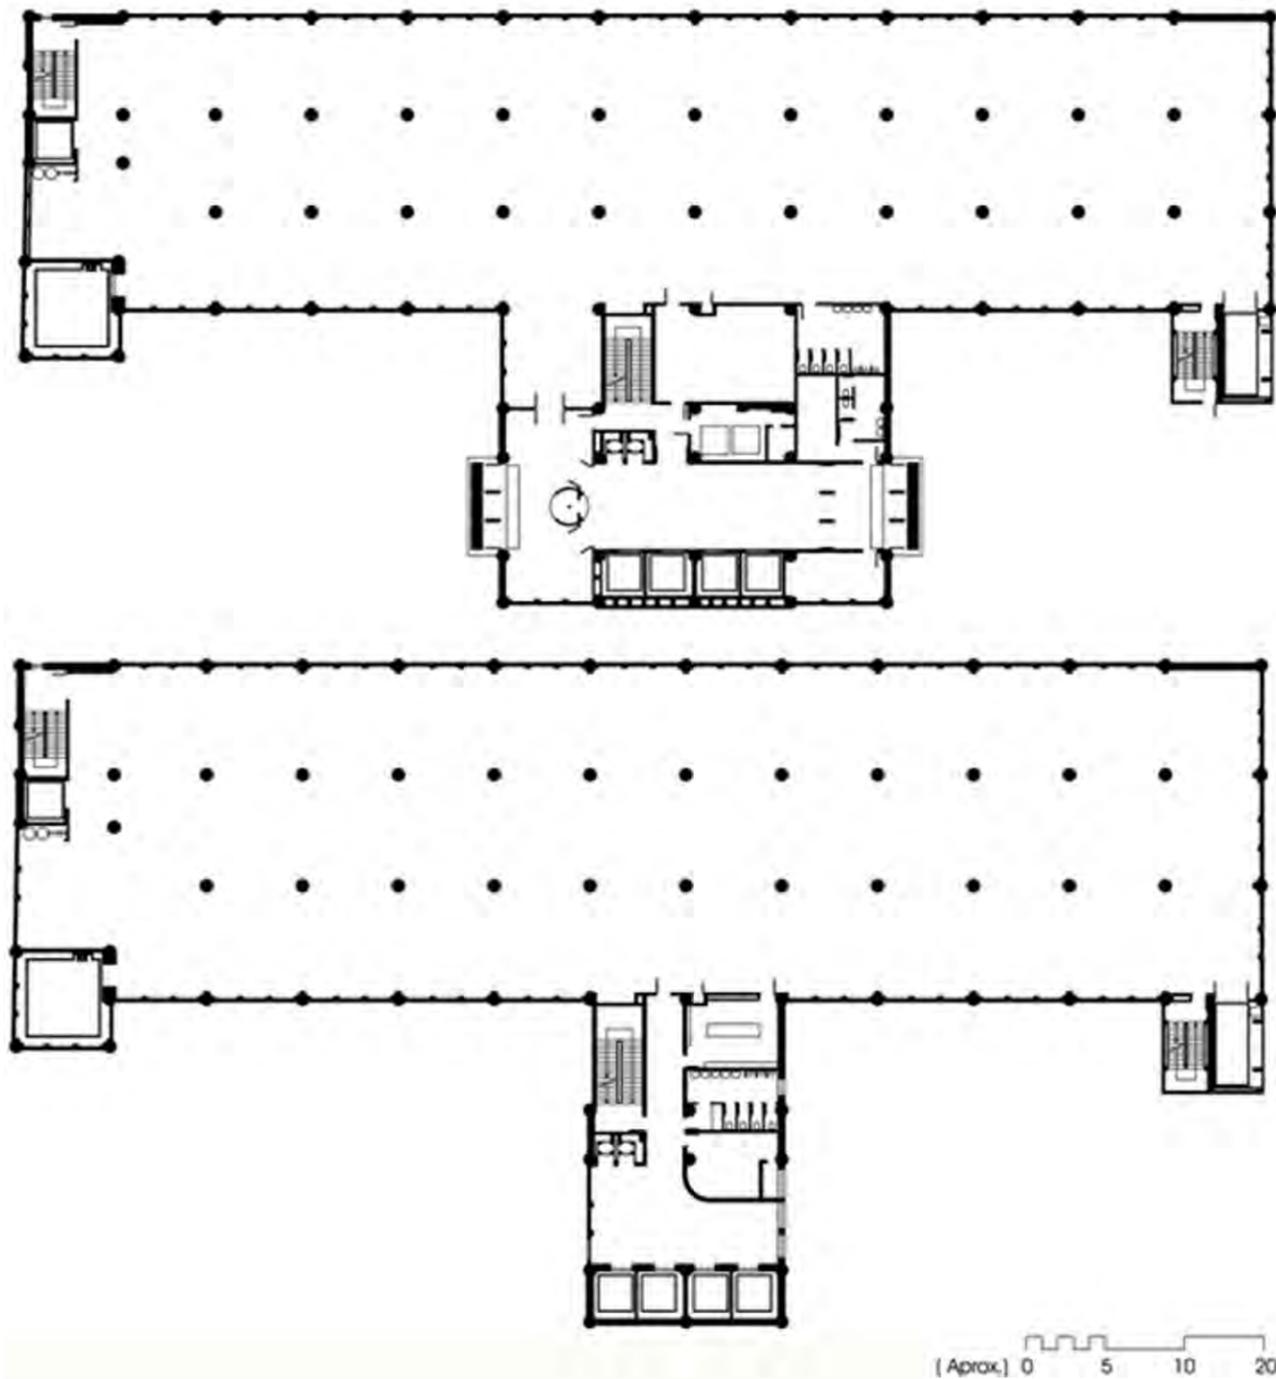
Reelaboración gráfica de las plantas del Edificio 21. Inf.: planta baja, sup.: planta tipo de los distintos niveles superiores (dibujo del autor).
